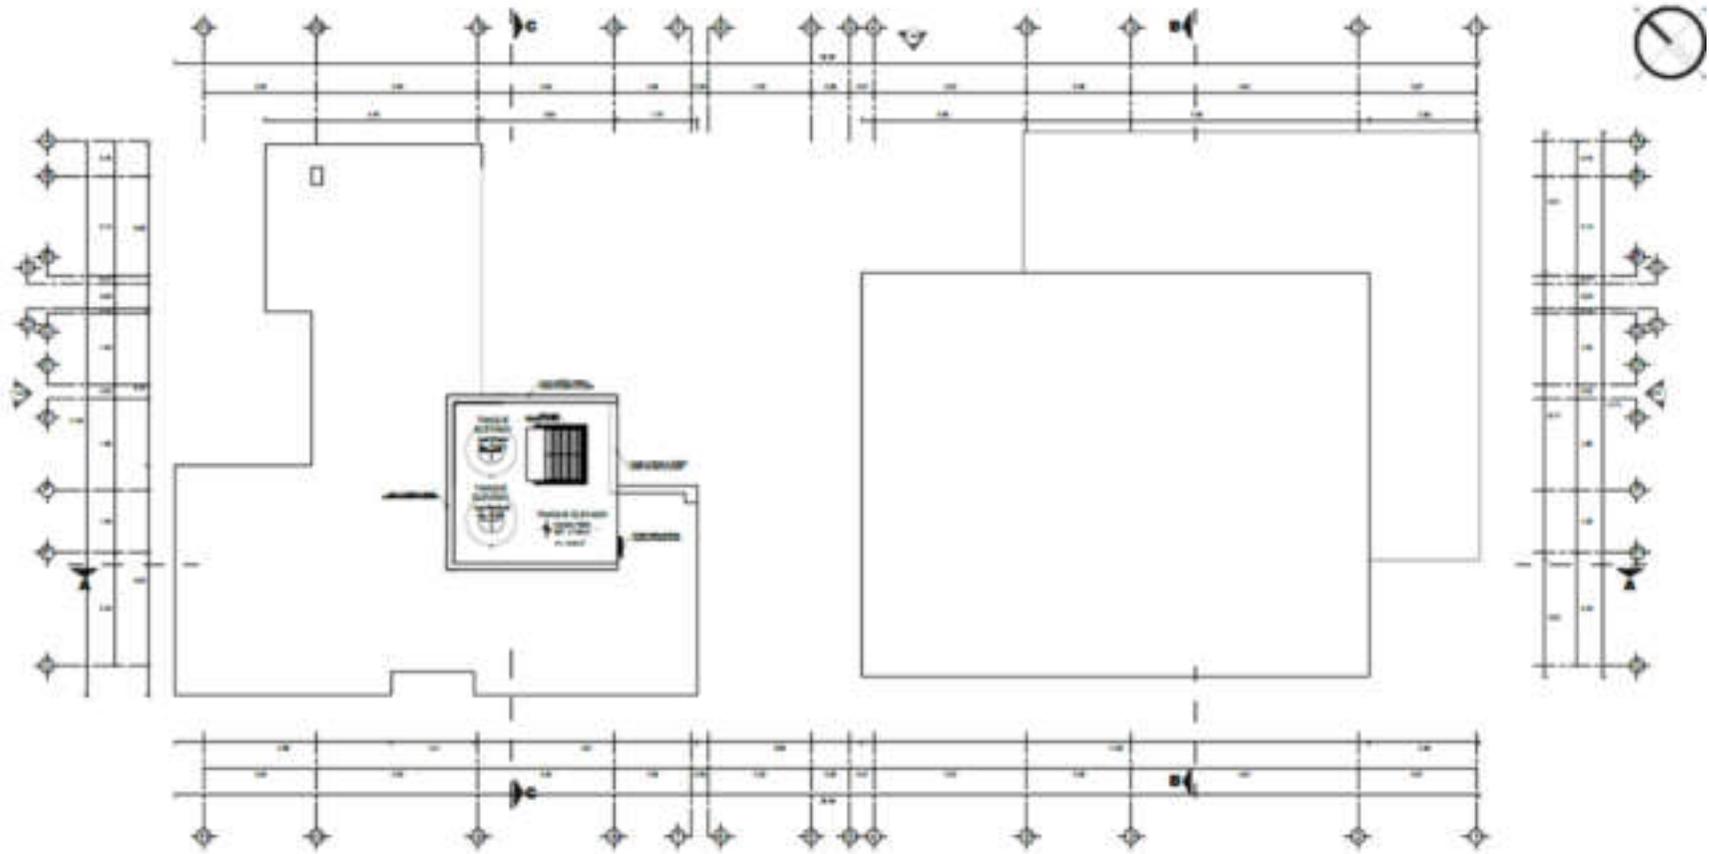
Planta de distribución, Nivel de tanque-Vivienda tipo I
